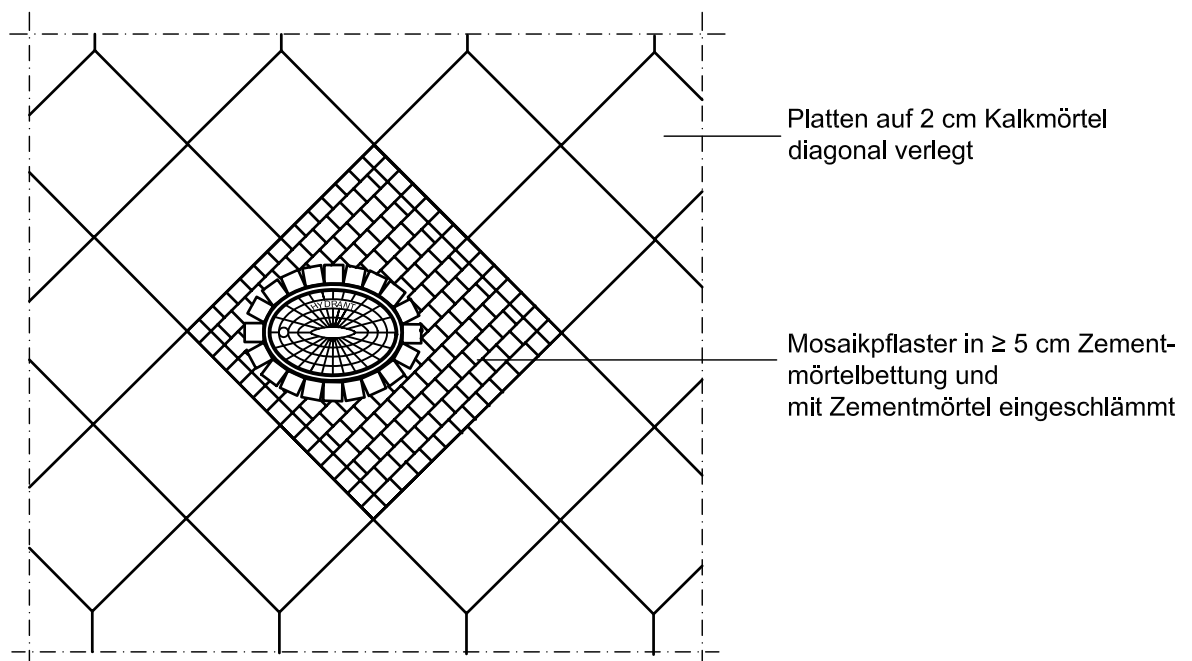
Hydrantenstraßenkappe mit Umpflasterung in Plattenbahn
